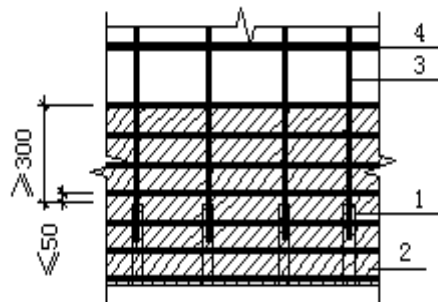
钢筋套筒灌浆连接部位水平分布钢筋的加密构造示意
